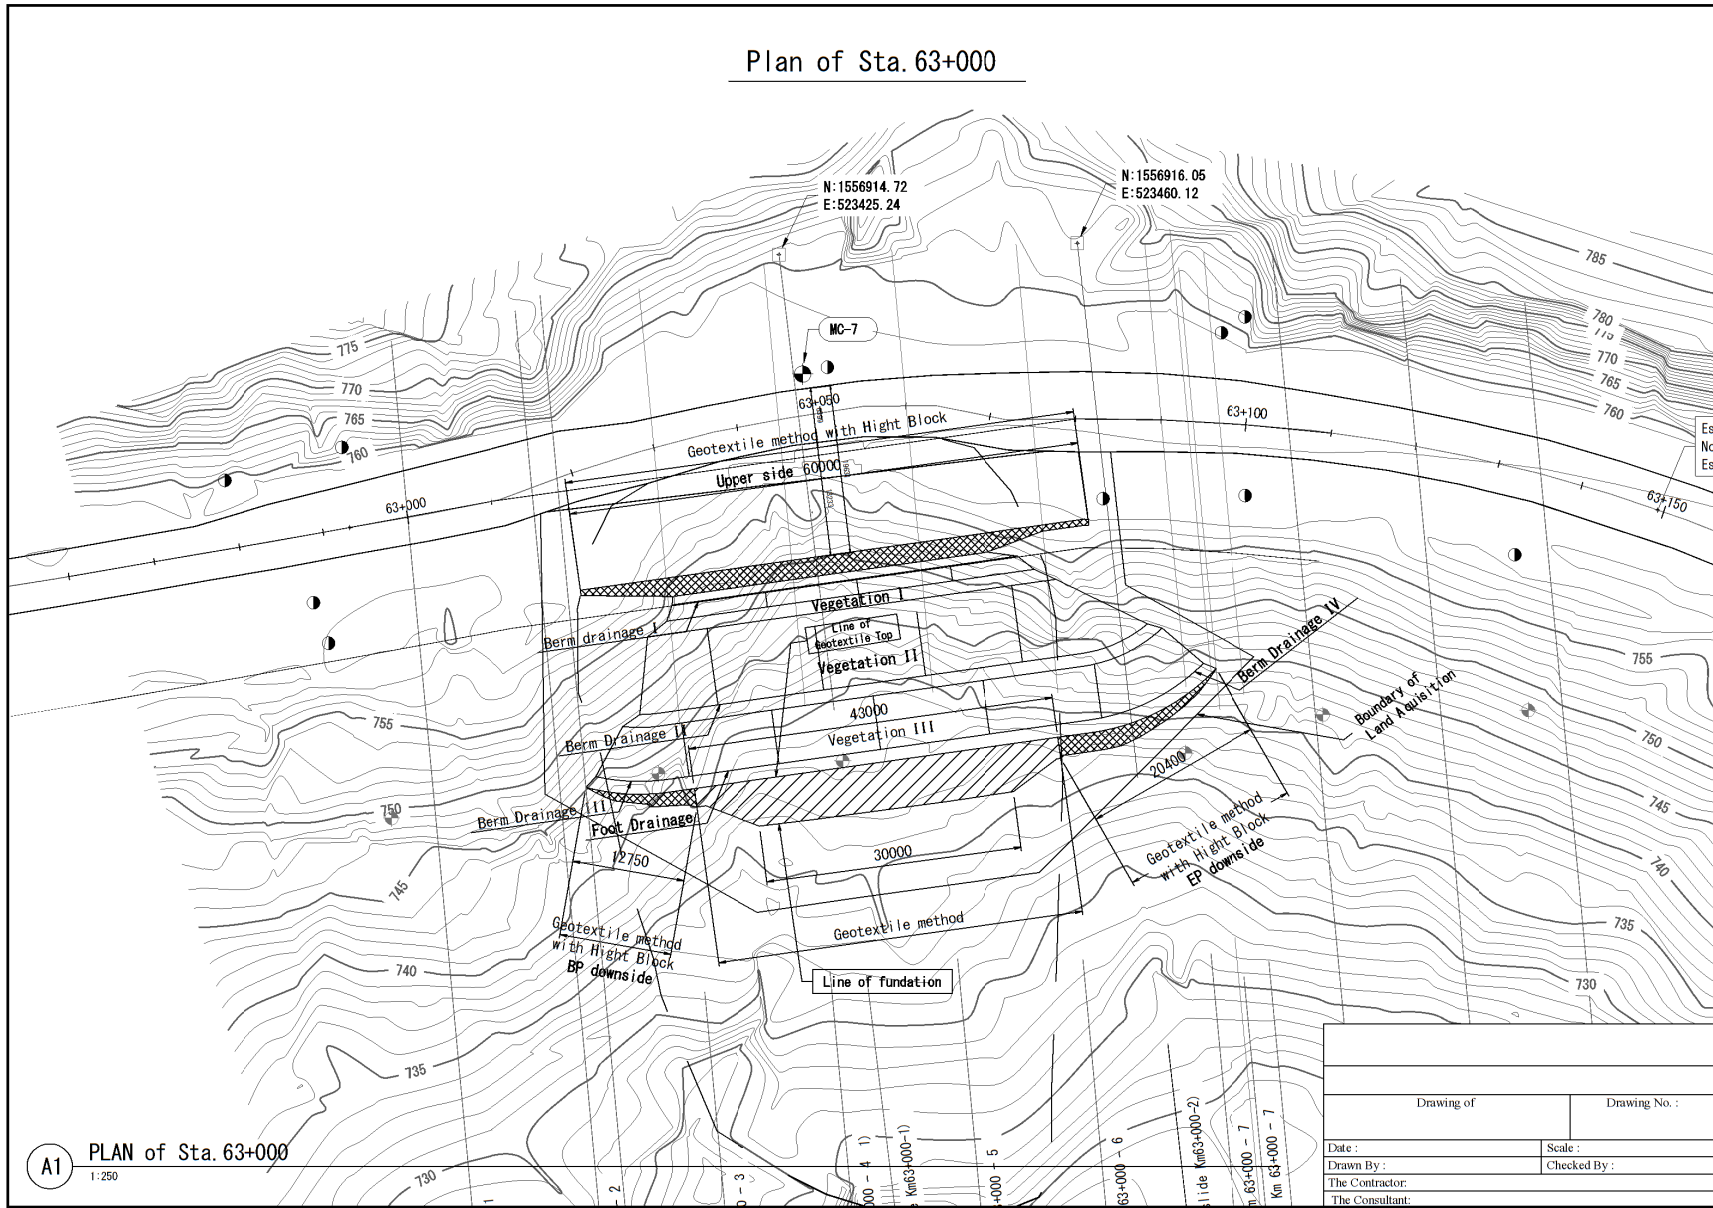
Sta.63+000 Vista de plano (Sin escala)
